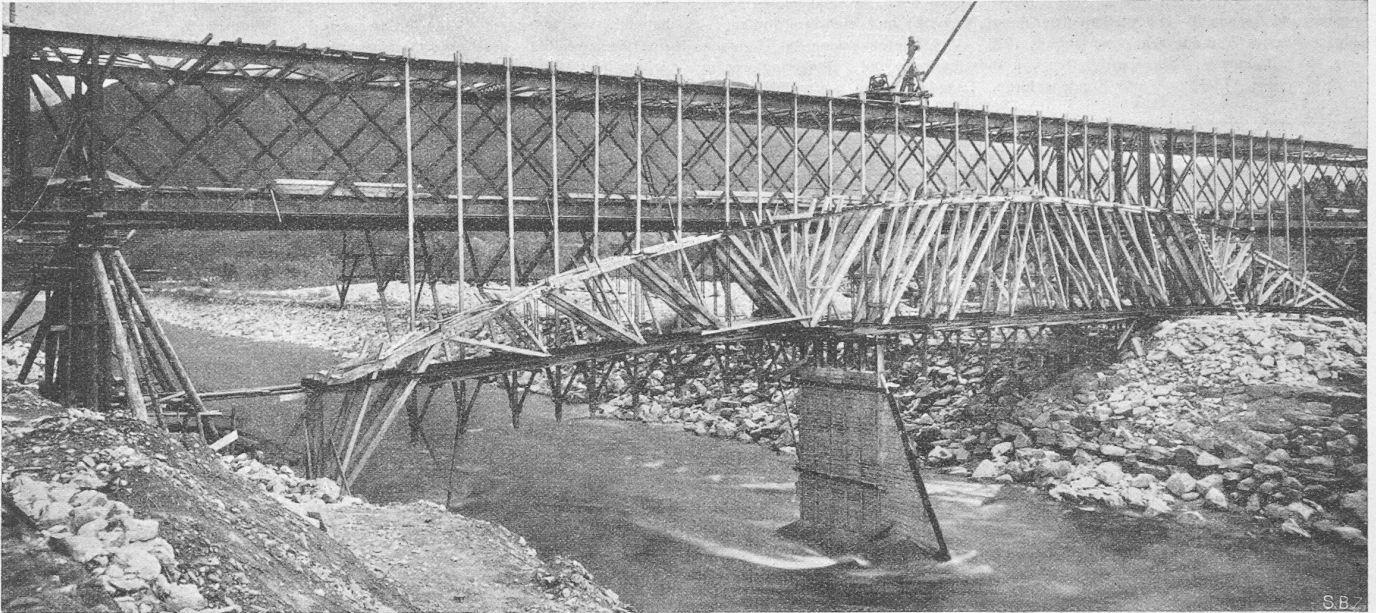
Lehrgerüst der Maggia-Brücke, Montage der Binder von der benachbarten eisernen Strassenbrücke aus.
